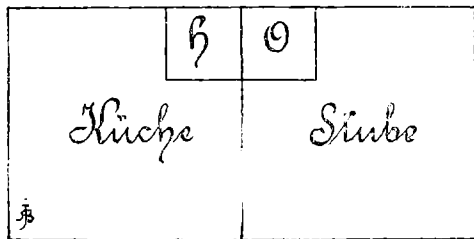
Grundriss eines oberdeutschen Hauses einfachster Form.
